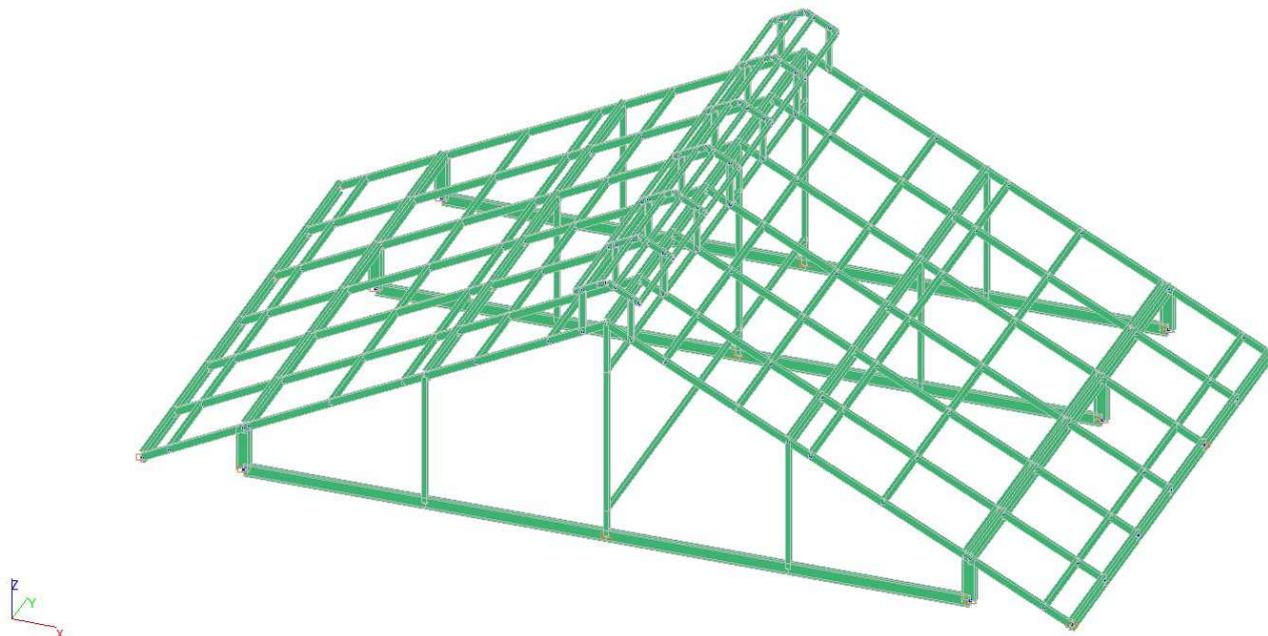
Расчётная схема стального каркаса покрытия здания в осях 1-3/А-В. (с объёмом элементов)
